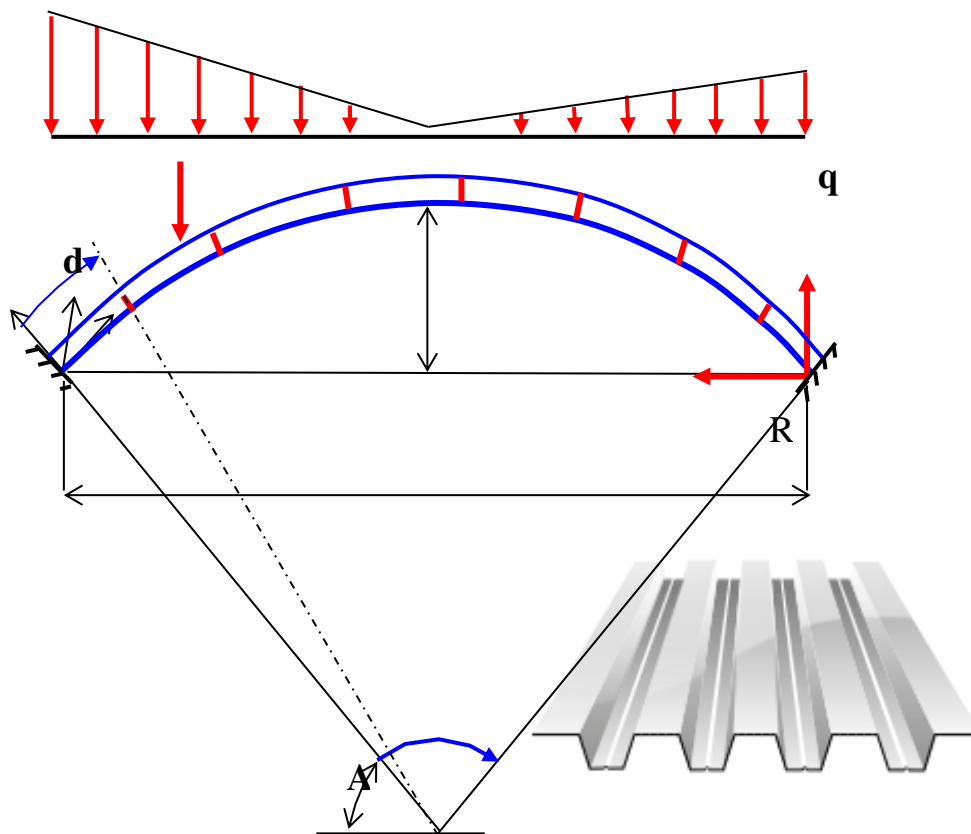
Первое основное сочетание нагрузок на арочное покрытие
